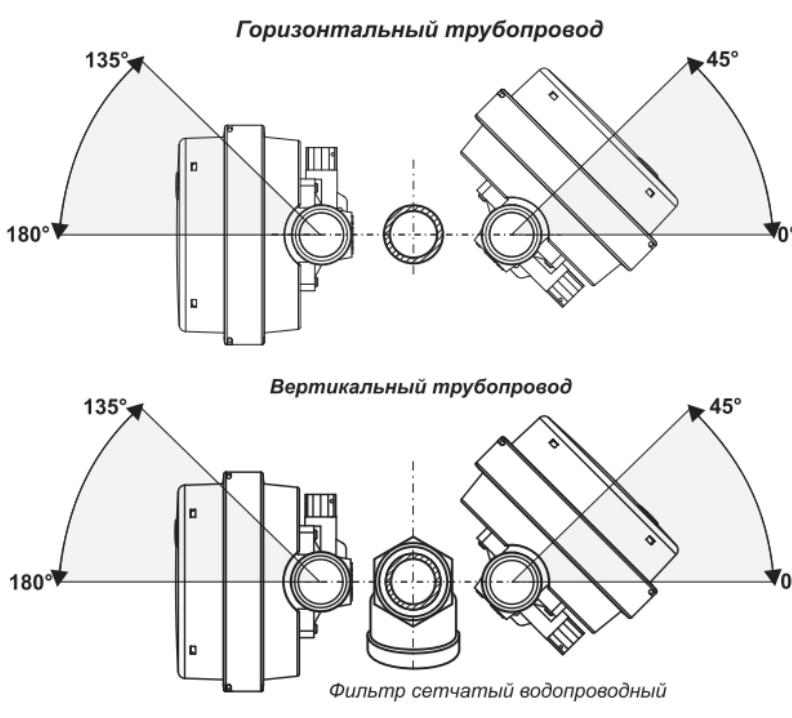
Монтаж КИПТ в трубопровод
